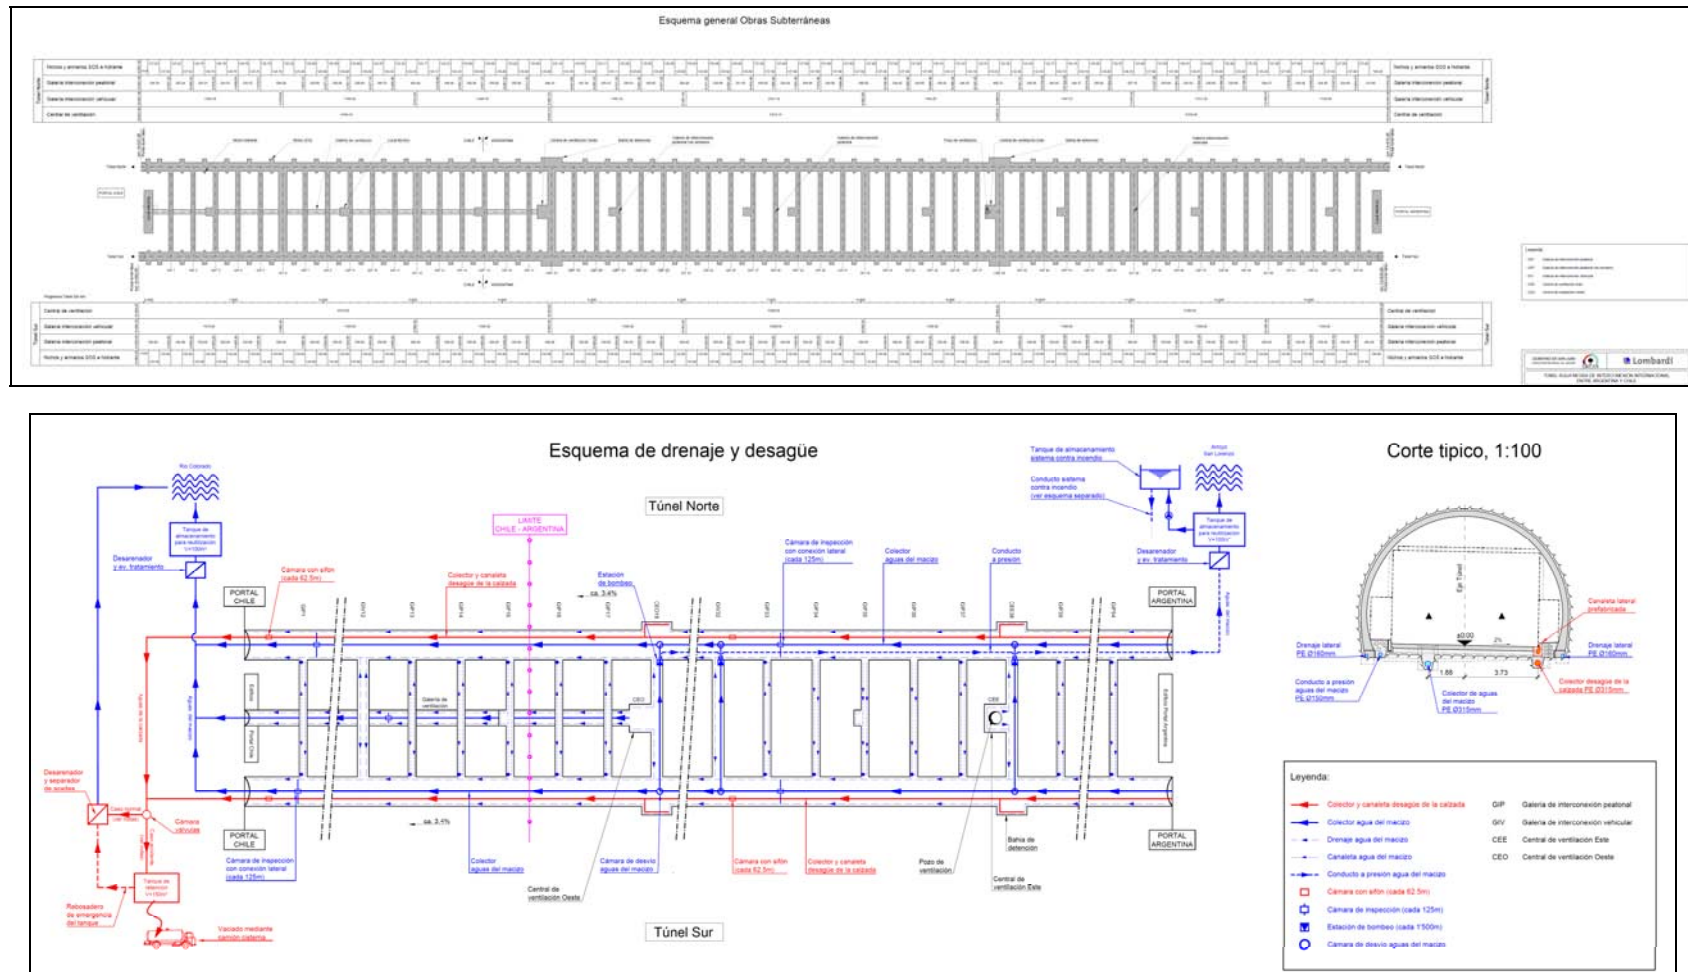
Esquema general de la obra y esquema de drenajes y desagües
